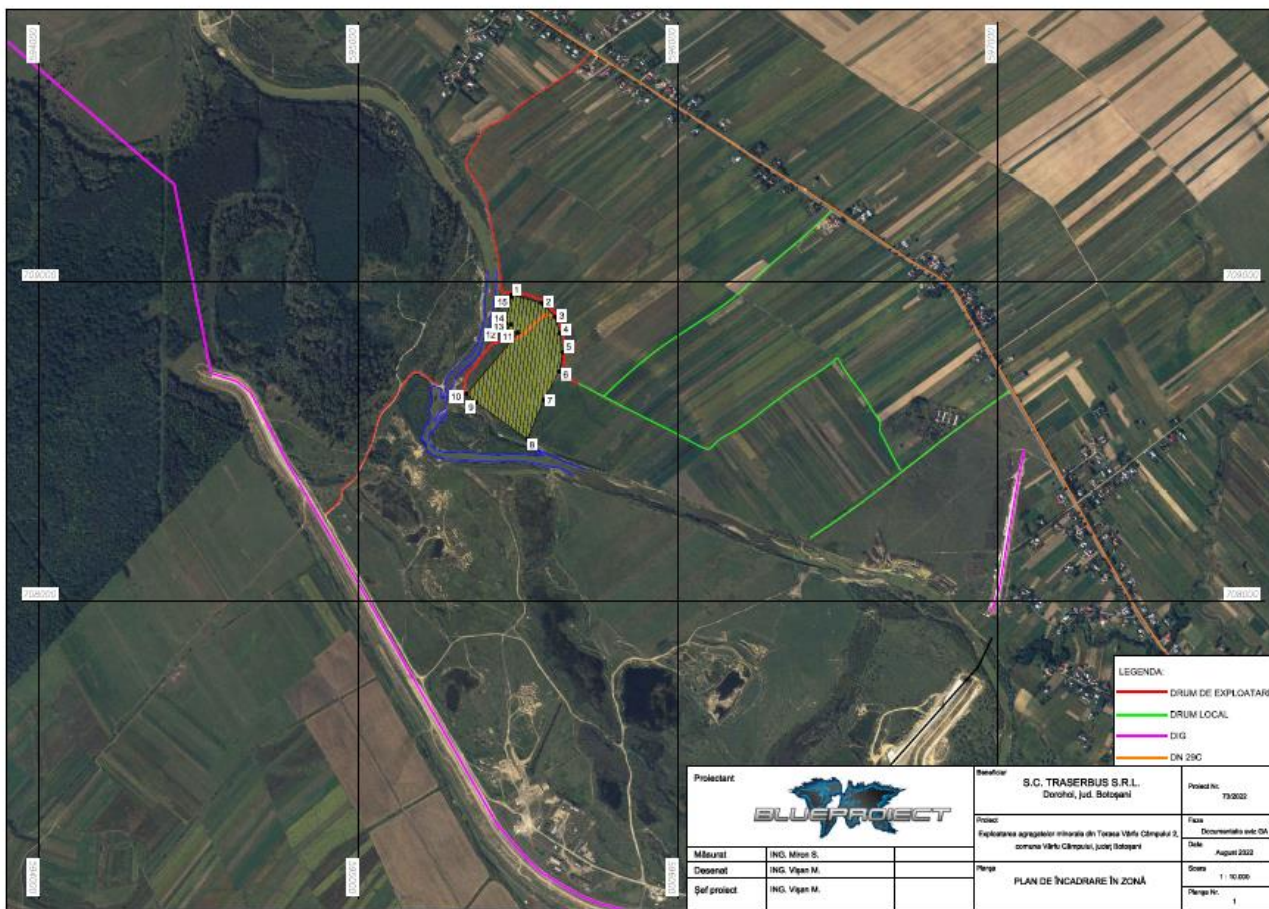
Plan de încadrare în zonă Terasa Vârfului Câmpului 2
